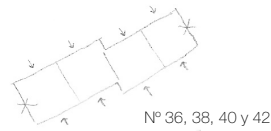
Bocetos en planta de la disposición de las construcciones situadas en la Rúa Bueu-Coia, nº 36, 38, 40 y 42 (autoría propia).
